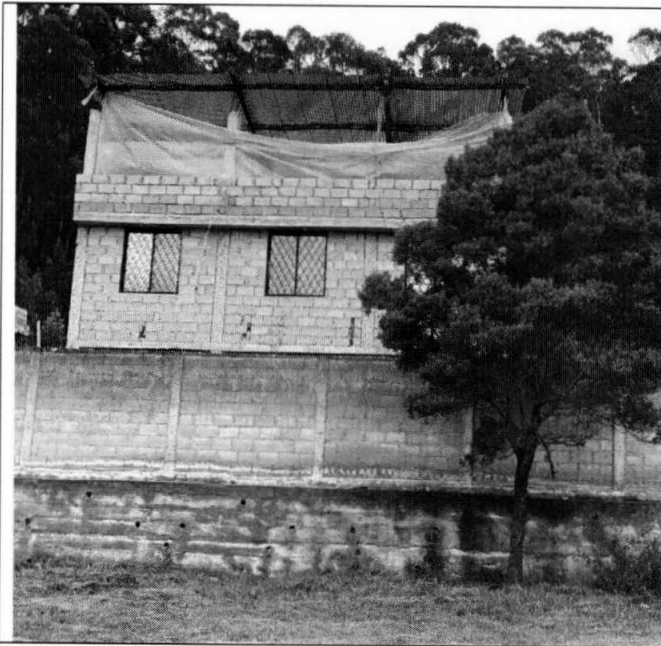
Vista Exterior / Construcción N° 4 / Parcialmente adosada en su lado este
